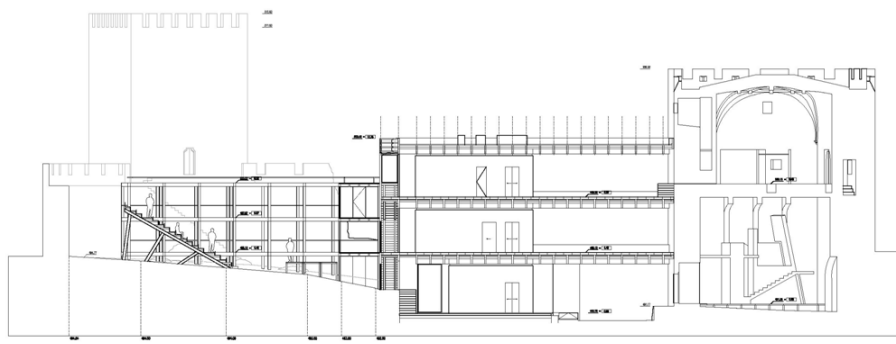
Pormenor da junção do novo elemento arquitectónico.
